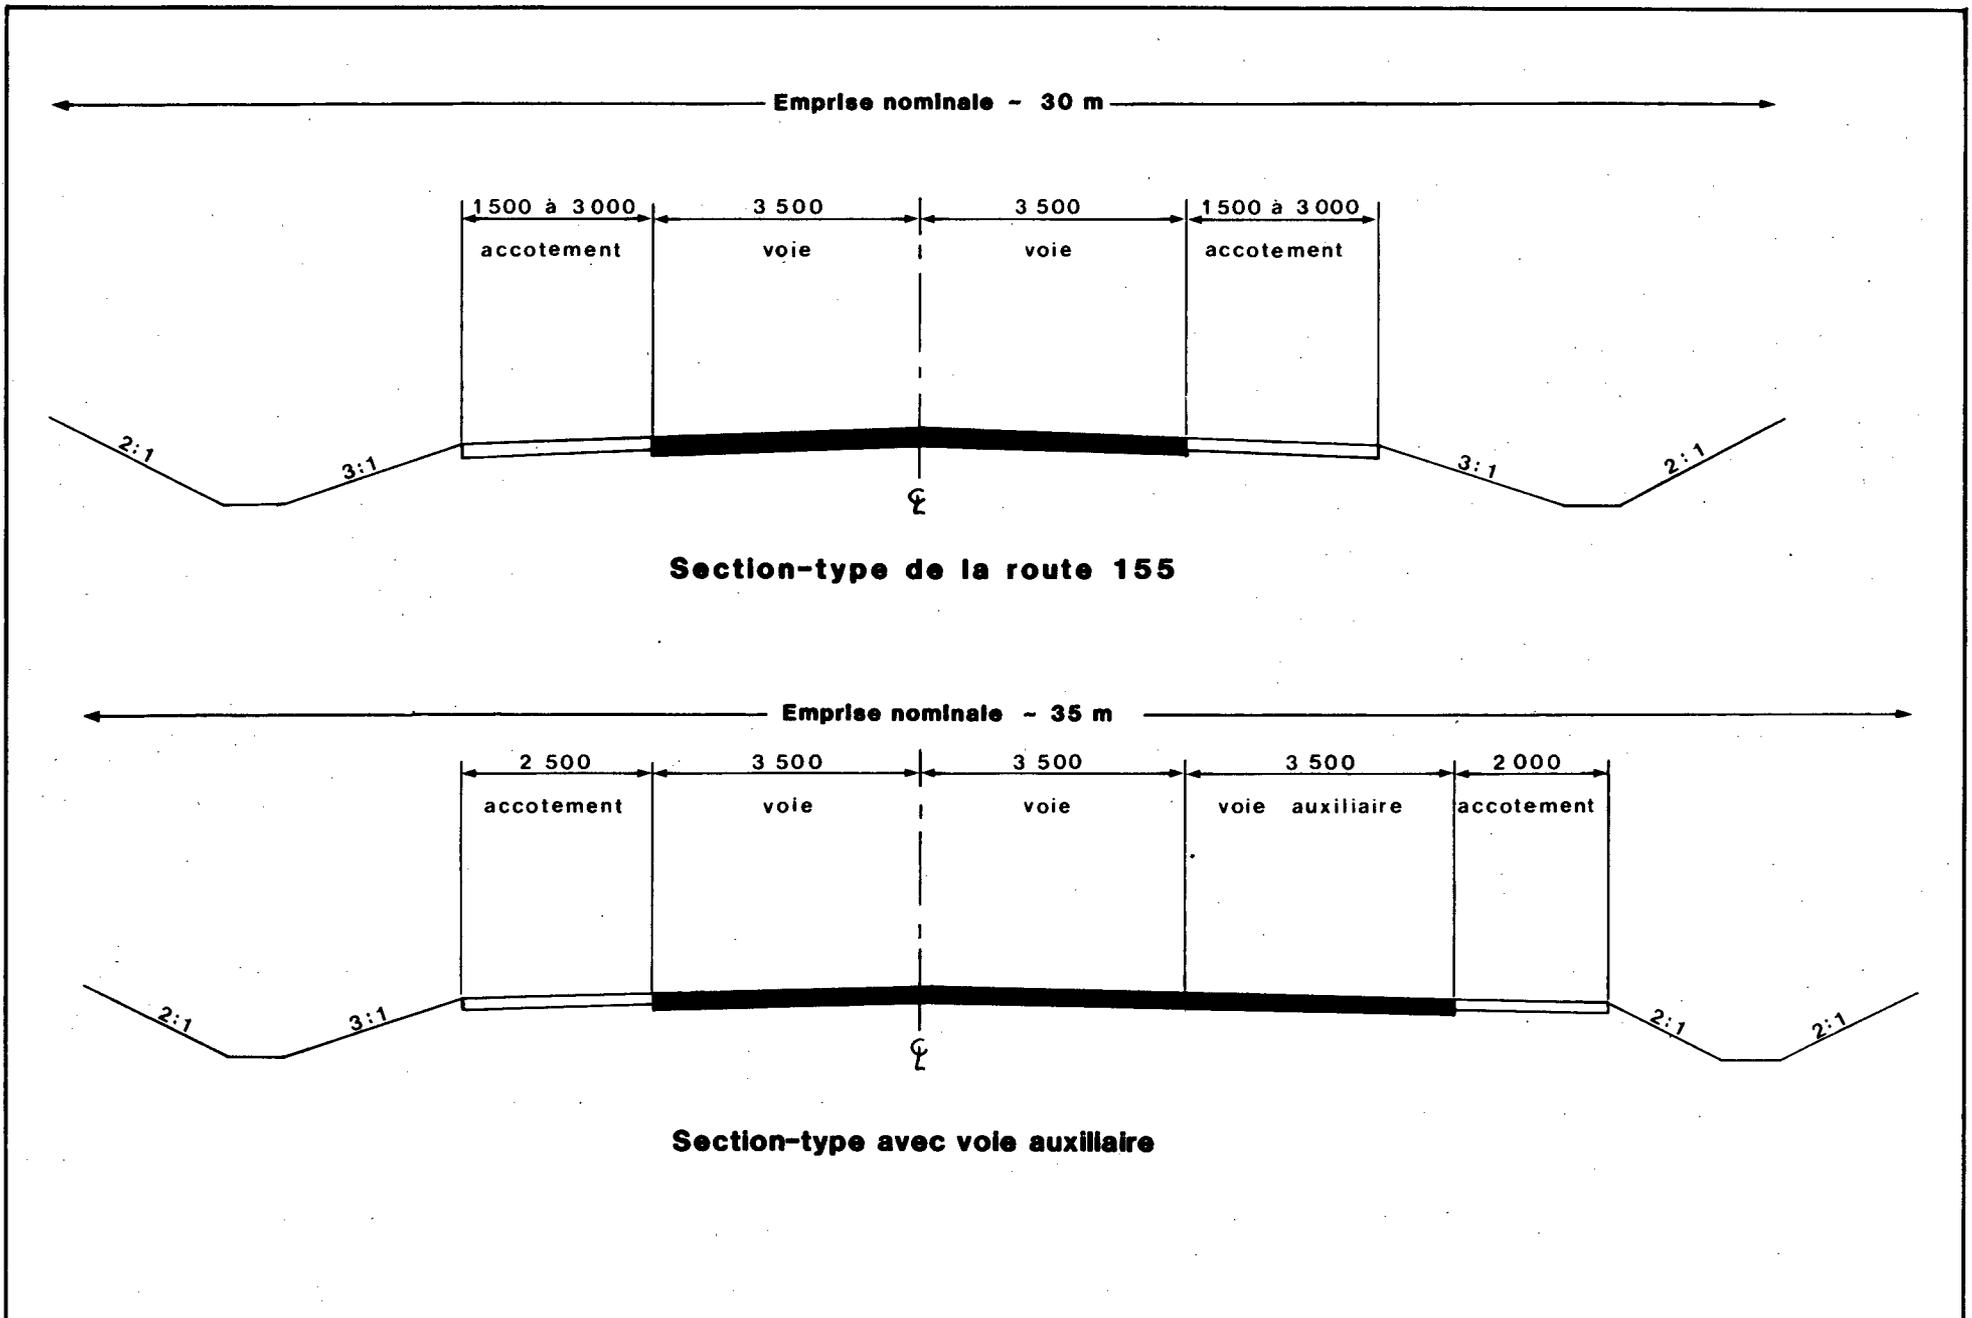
SECTION-TYPE DE LA ROUTE 155 & SECTION-TYPE AVEC VOIE AUXILIAIRE
